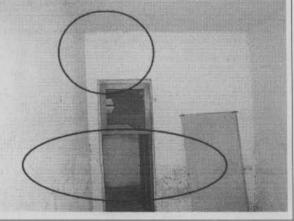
Fisuras en algunos muros y desprendimiento de acabados en el interior del inmueble.
